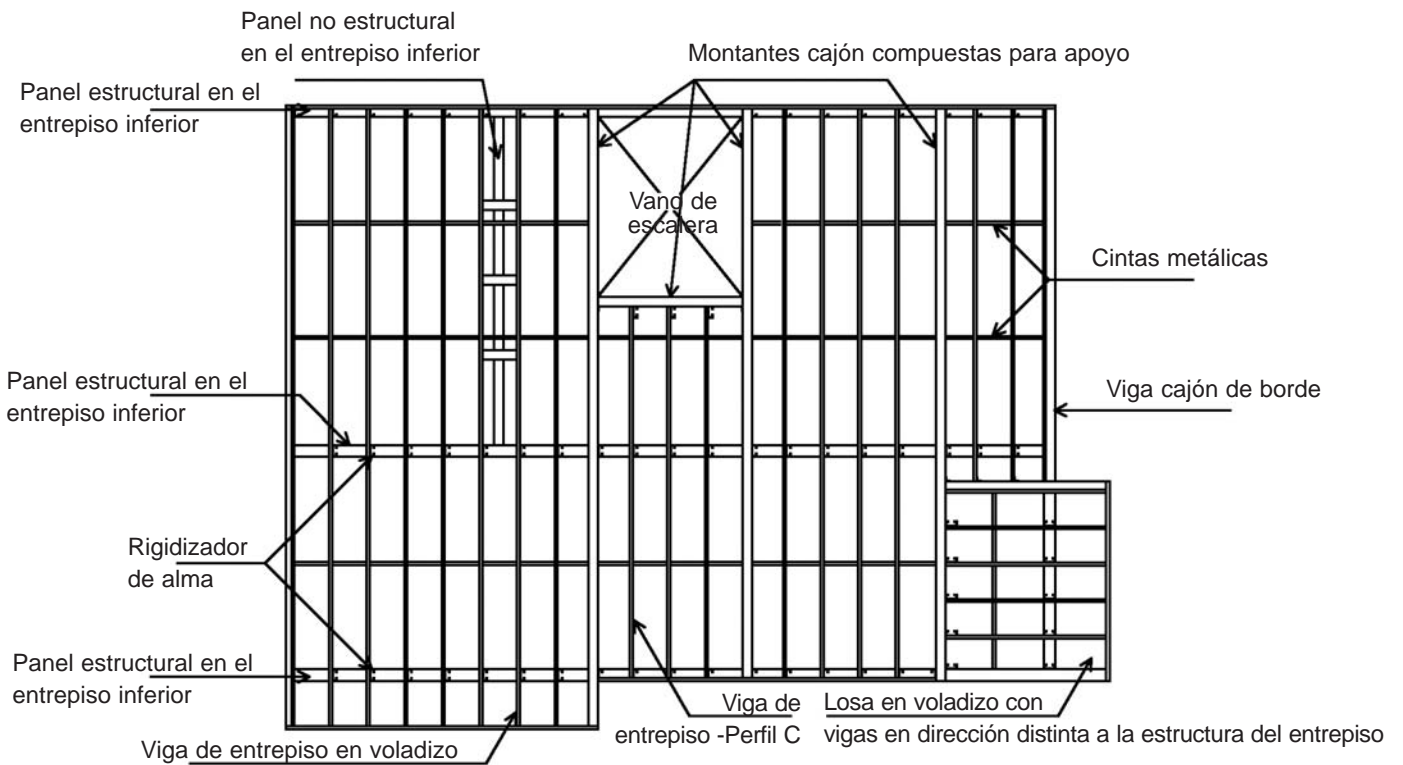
Ejemplo de planta de estructura de entrapiso en Steel Framing
